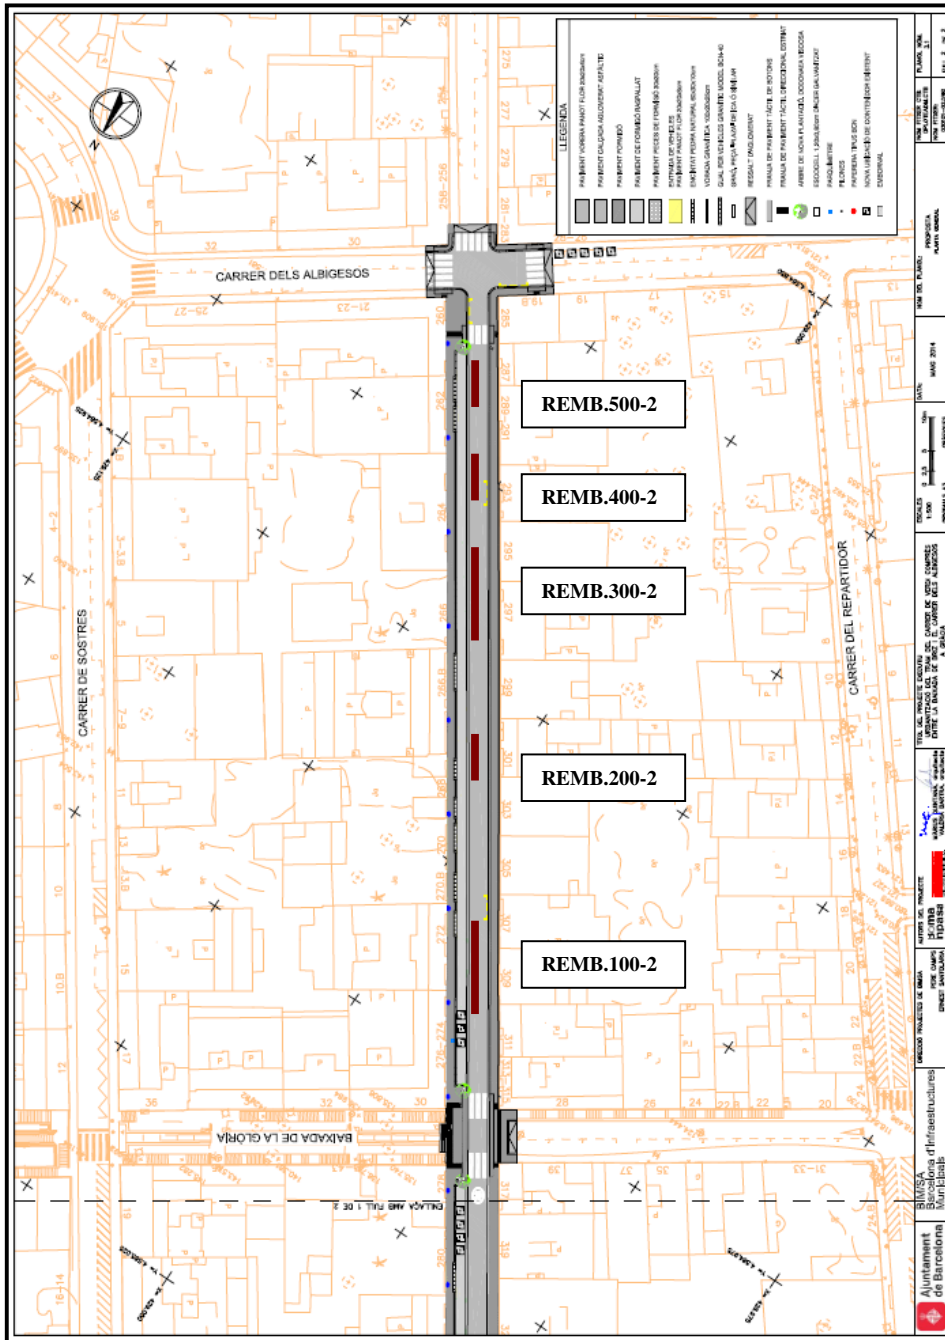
Planimetria facilitada per Ajuntament de Barcelona-Servei d'Arqueologia de Barcelona.
